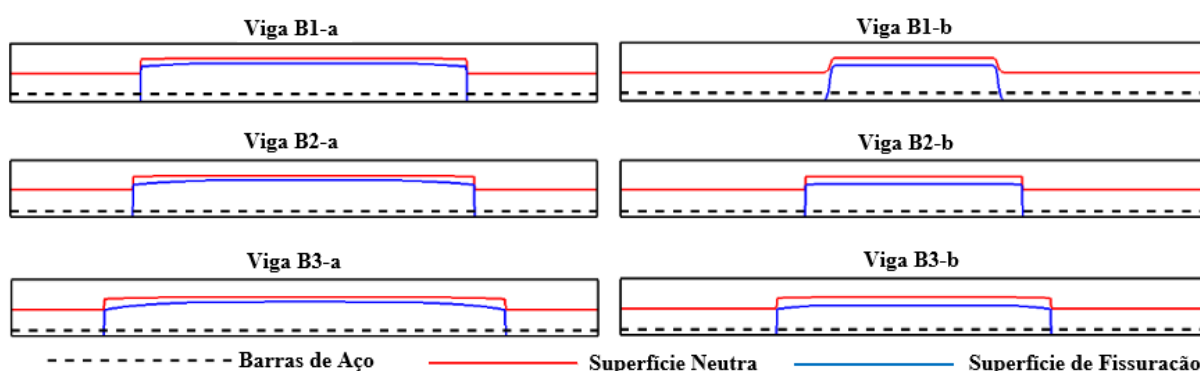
Região de fissuração das vigas ensaiadas por Gilbert e Nejadi (2004). Fonte: O Autor (2016).
